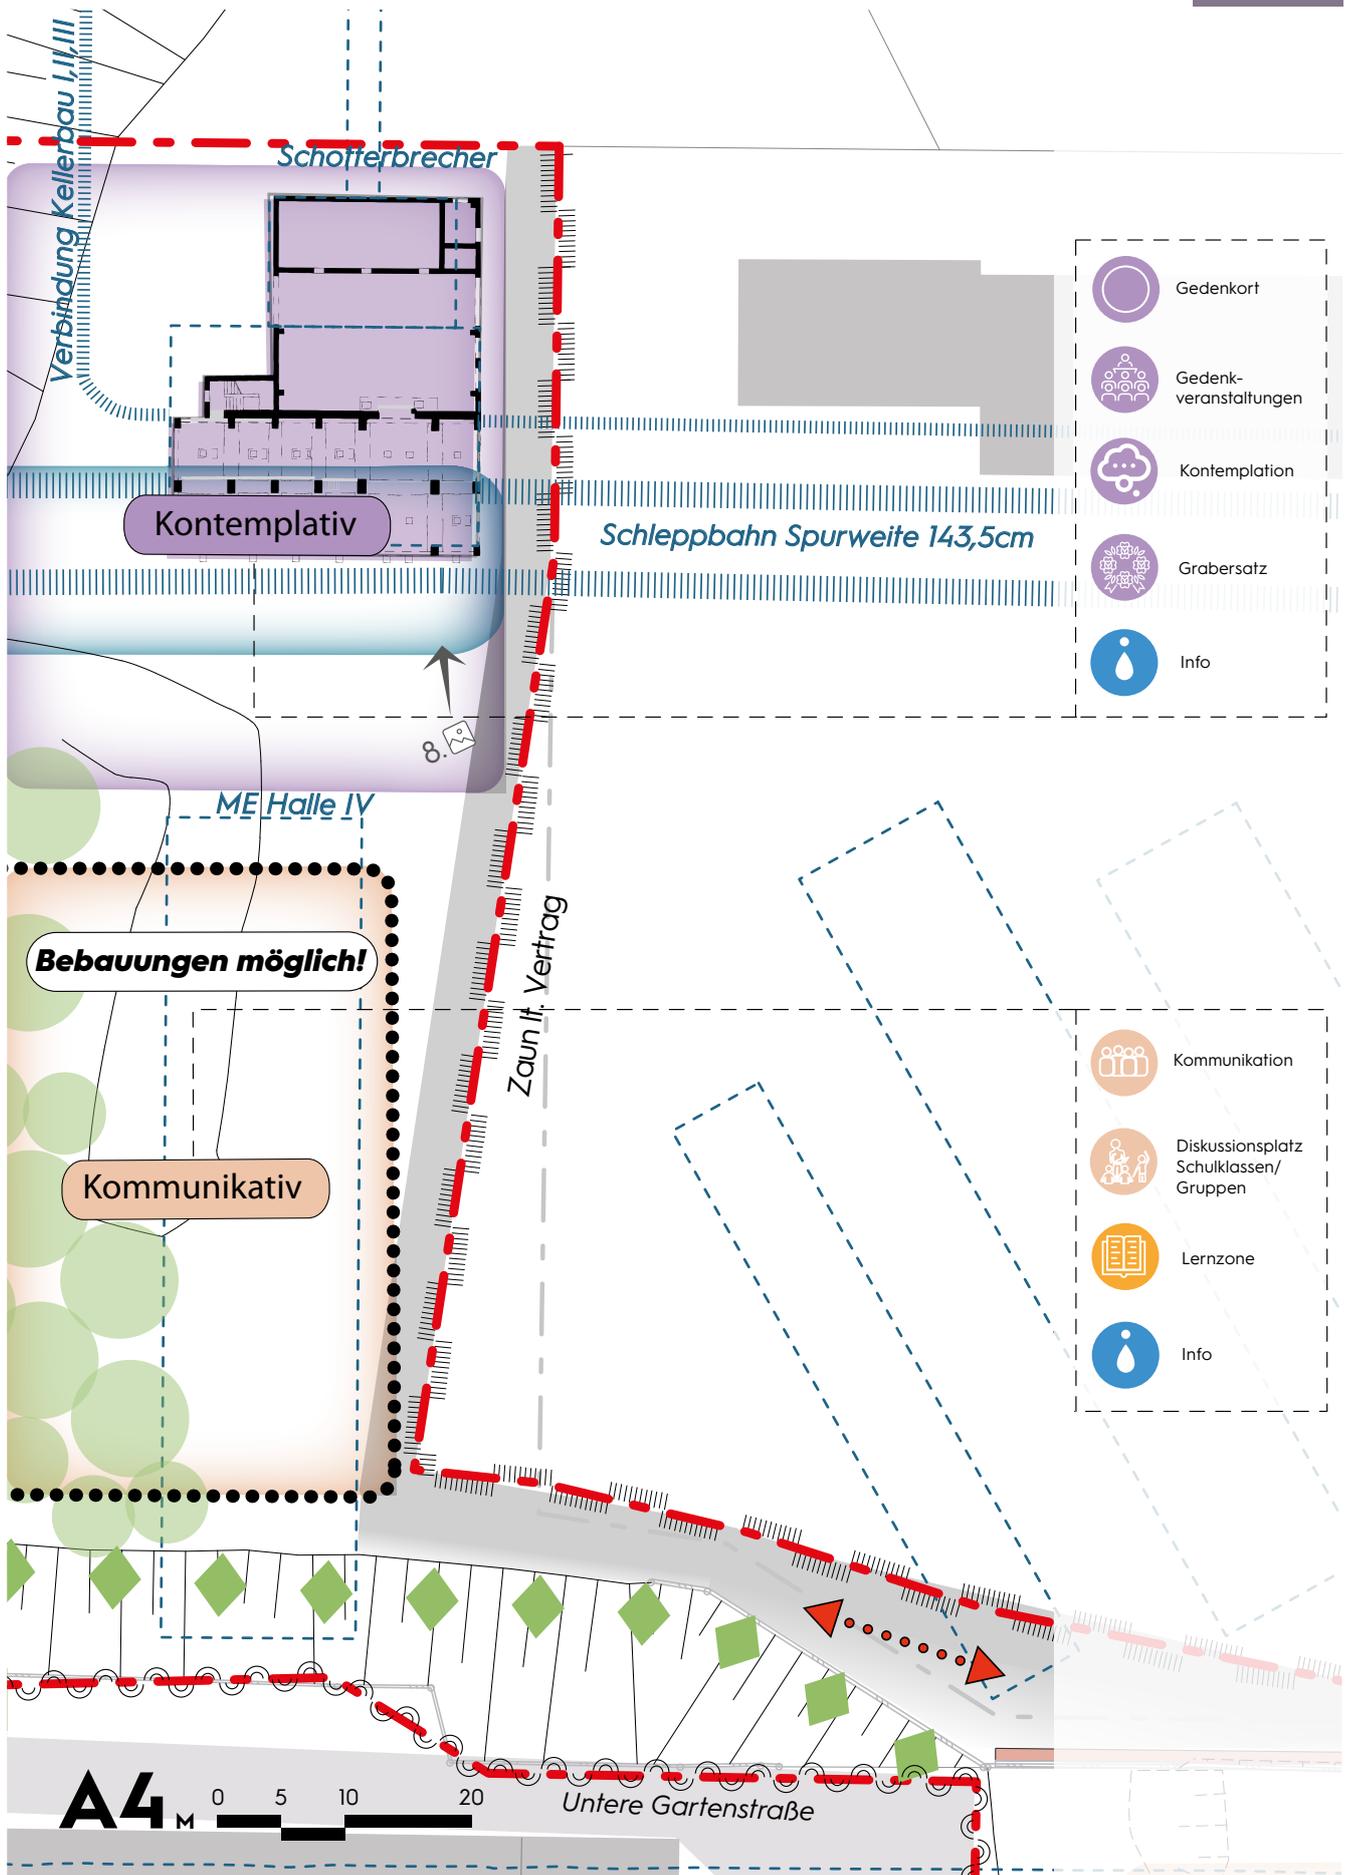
Masterplan Grundriss Appellplatz (Ausschnitt A4)
